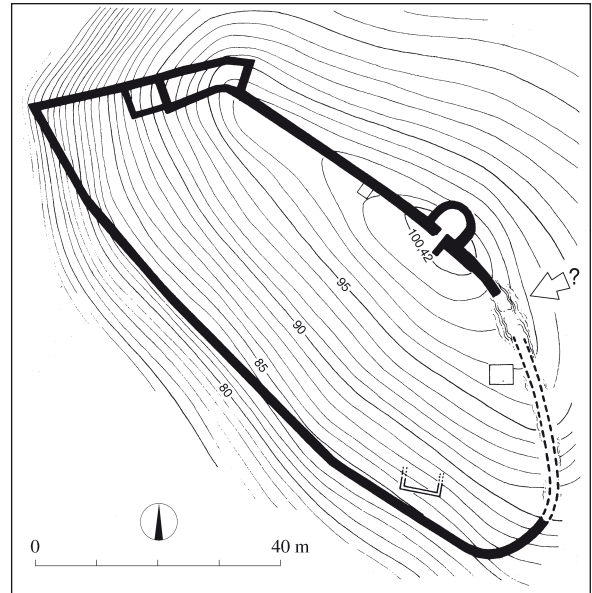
Babrež-Gaj. Grundriss (nach Premović-Aleksić 2014, Abb. 318).
